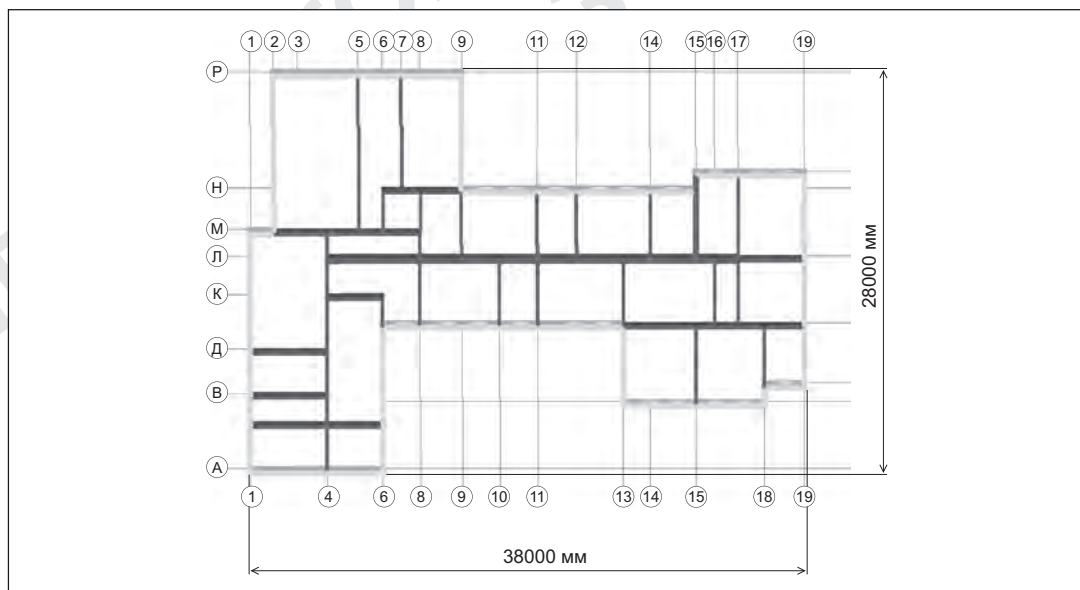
Схема типового этажа (наружные несущие кирпичные стены толщиной 640 мм, внутренние кирпичные стены толщиной 380 мм)
